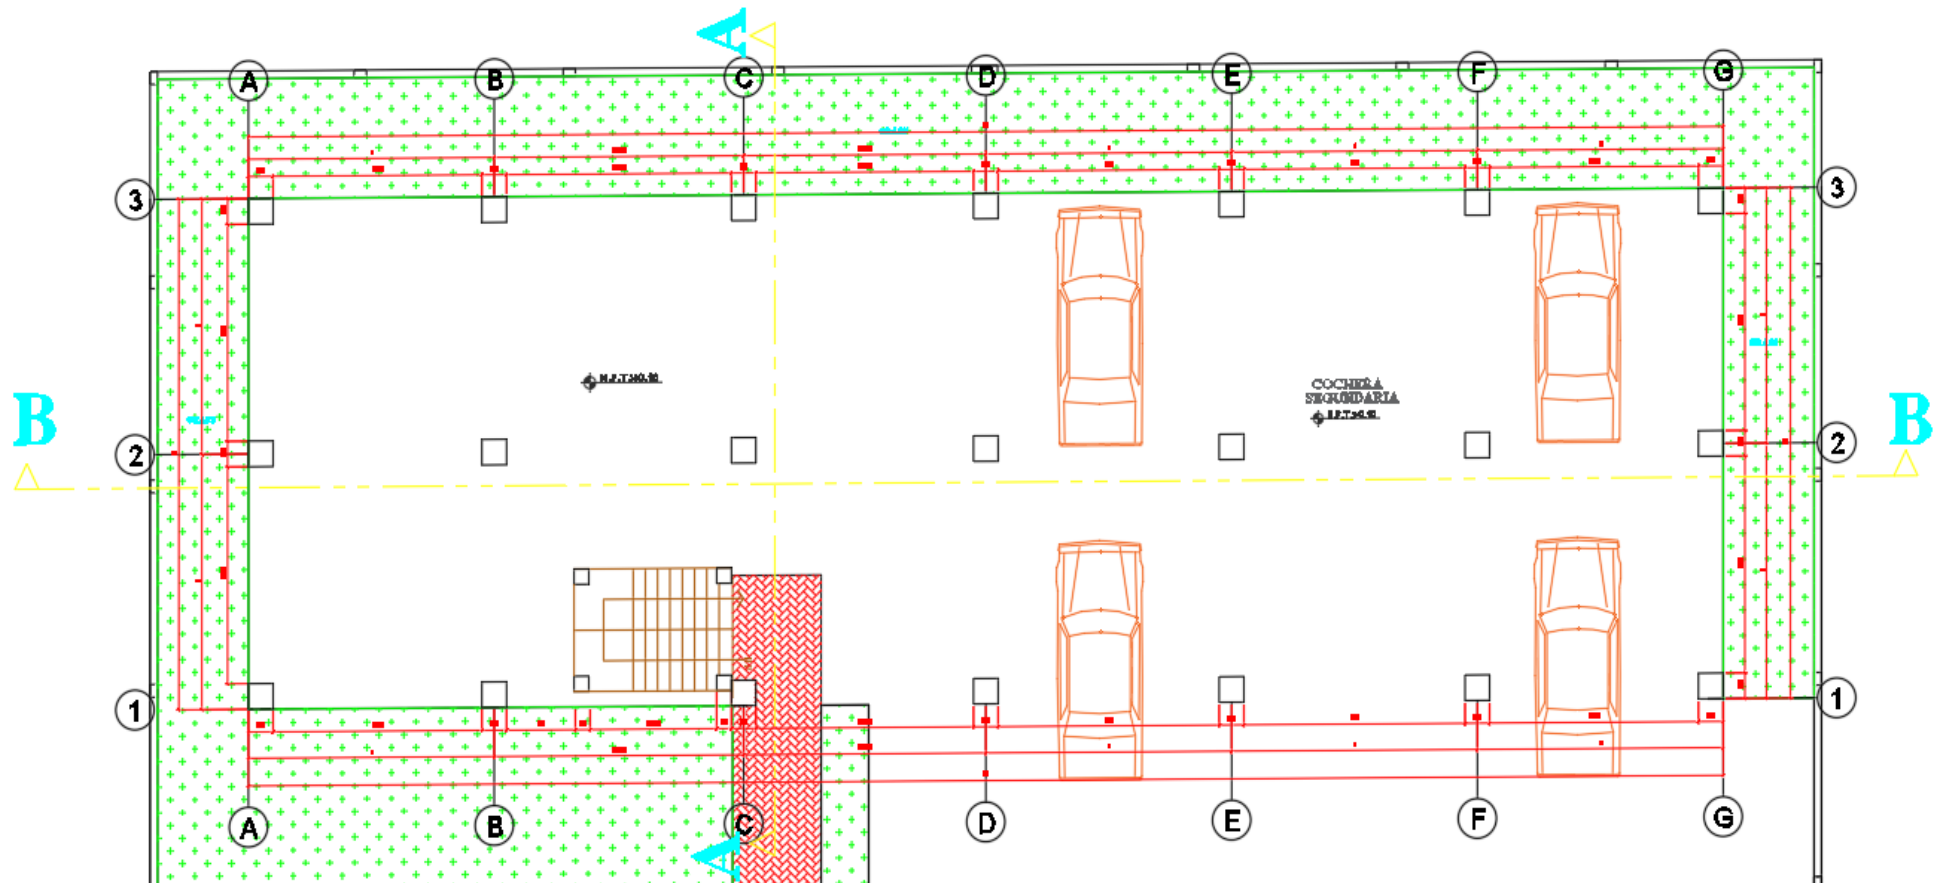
Distribución arquitectónica del 1° nivel de la edificación del sistema a porticado.
